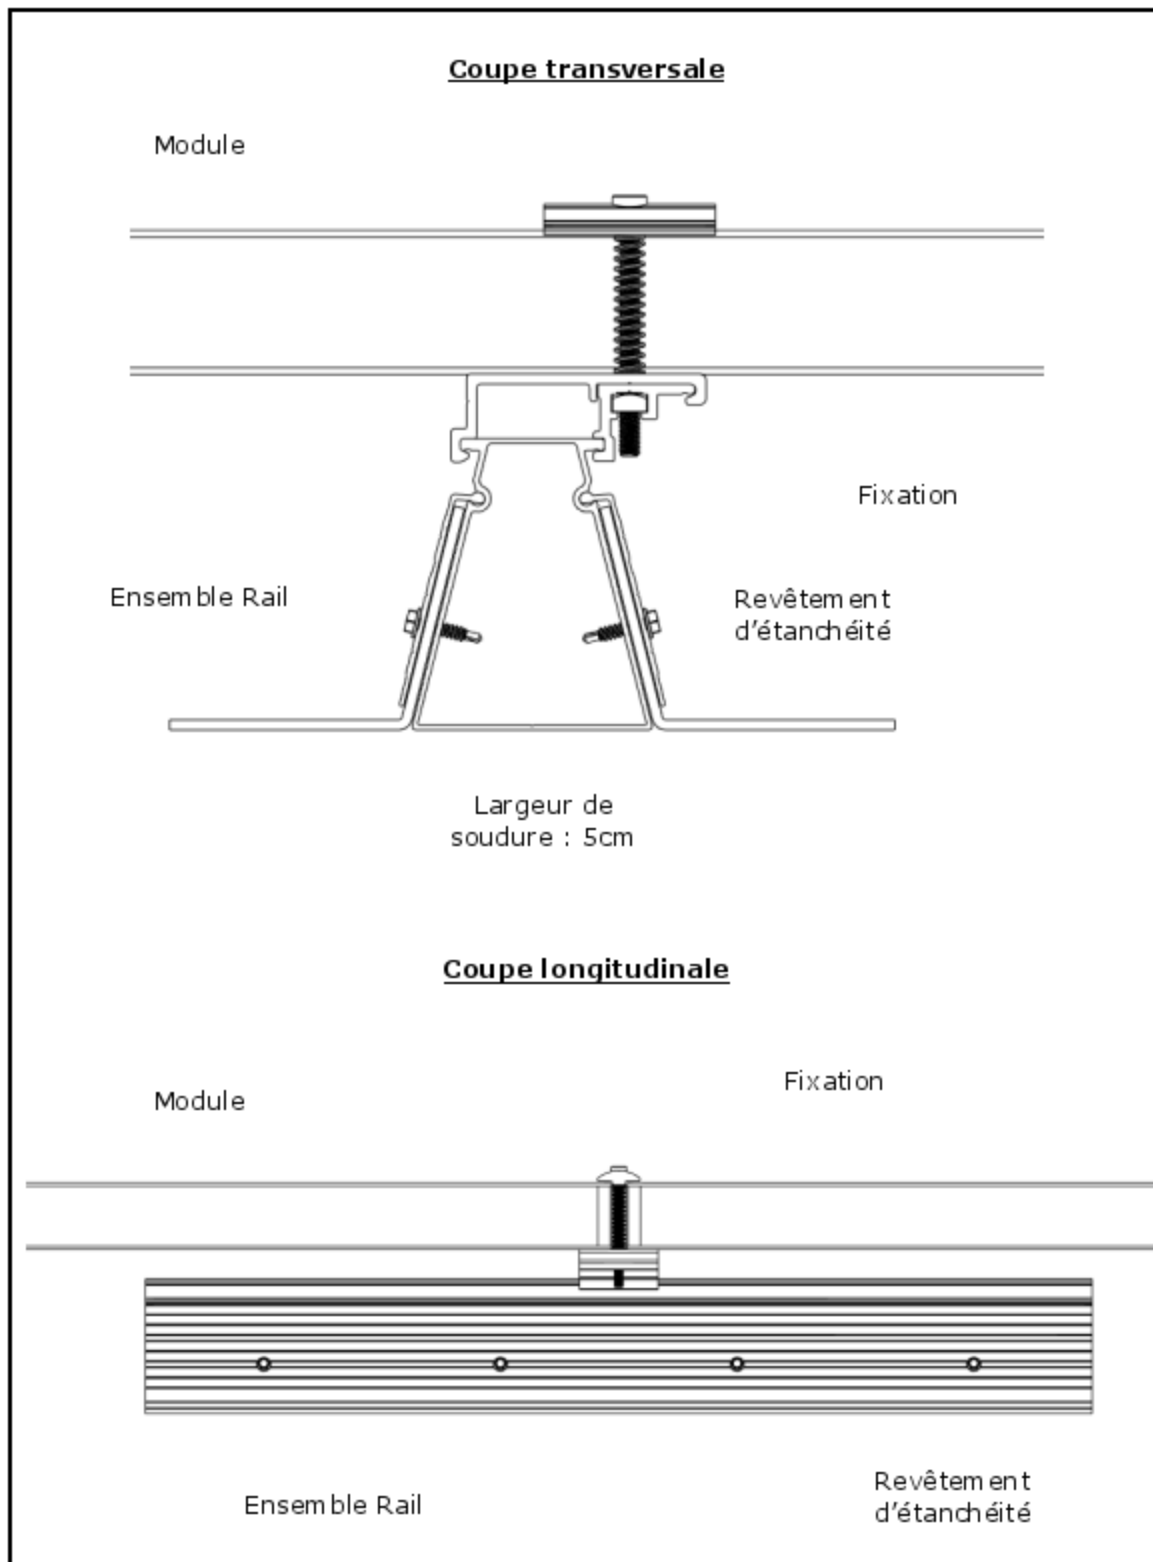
Assemblage ensemble « Rail » / fixation / module
